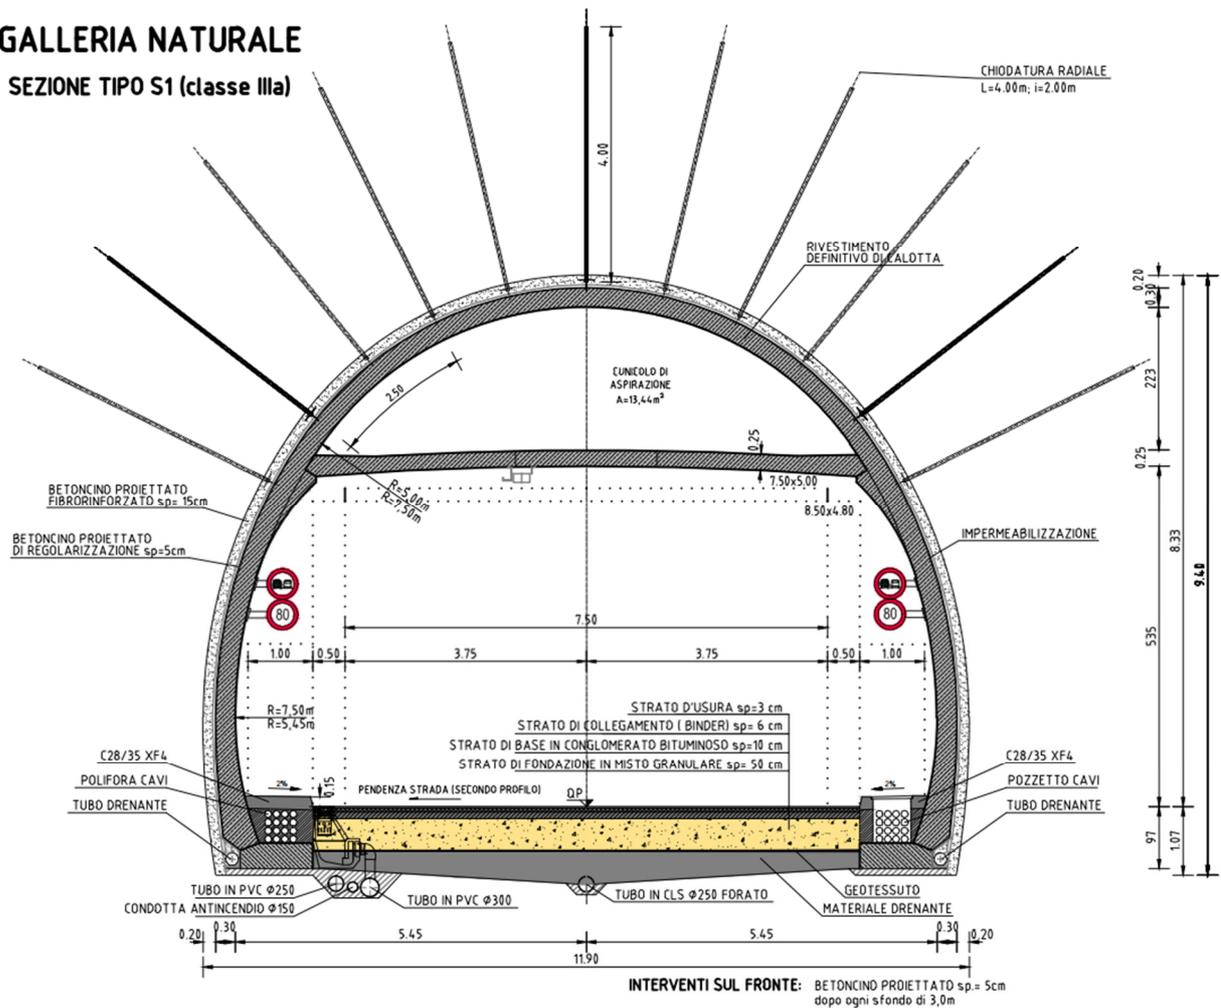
Regelquerschnitt / Tav. 4 Sezione tipo
